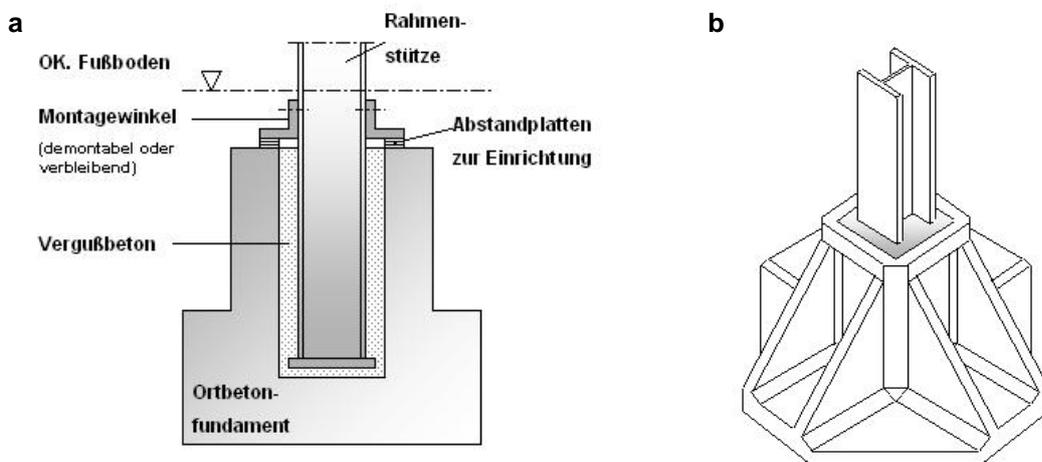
Köcherfundamente in Ortbetonbauweise und als Fertigteil
